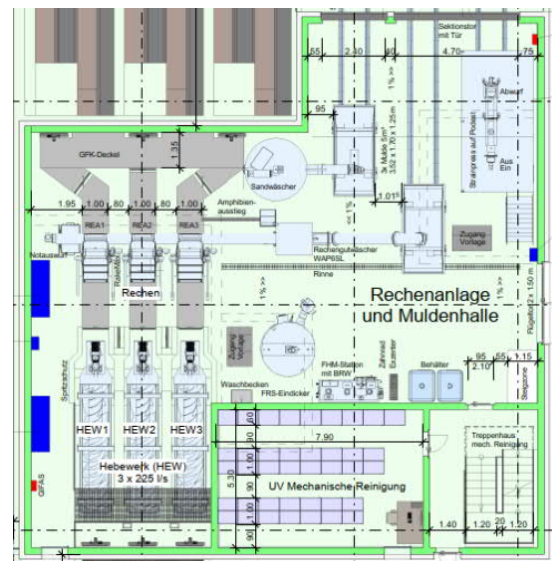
Planausschnitt; Grundriss EG
